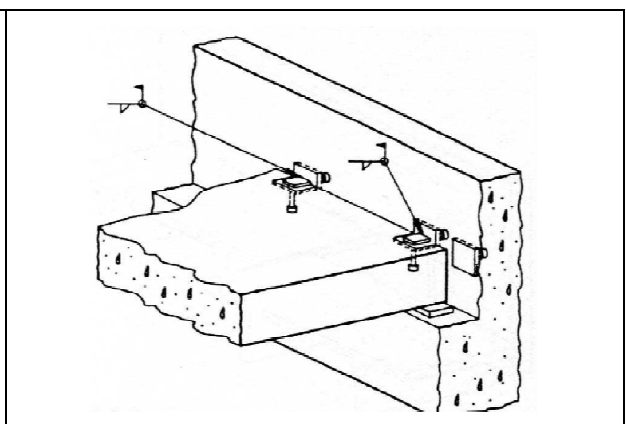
Ligação de laje com chapas aparafusadas na laje, assente em neoprene , perpendiculares à laje de piso (PCI)
